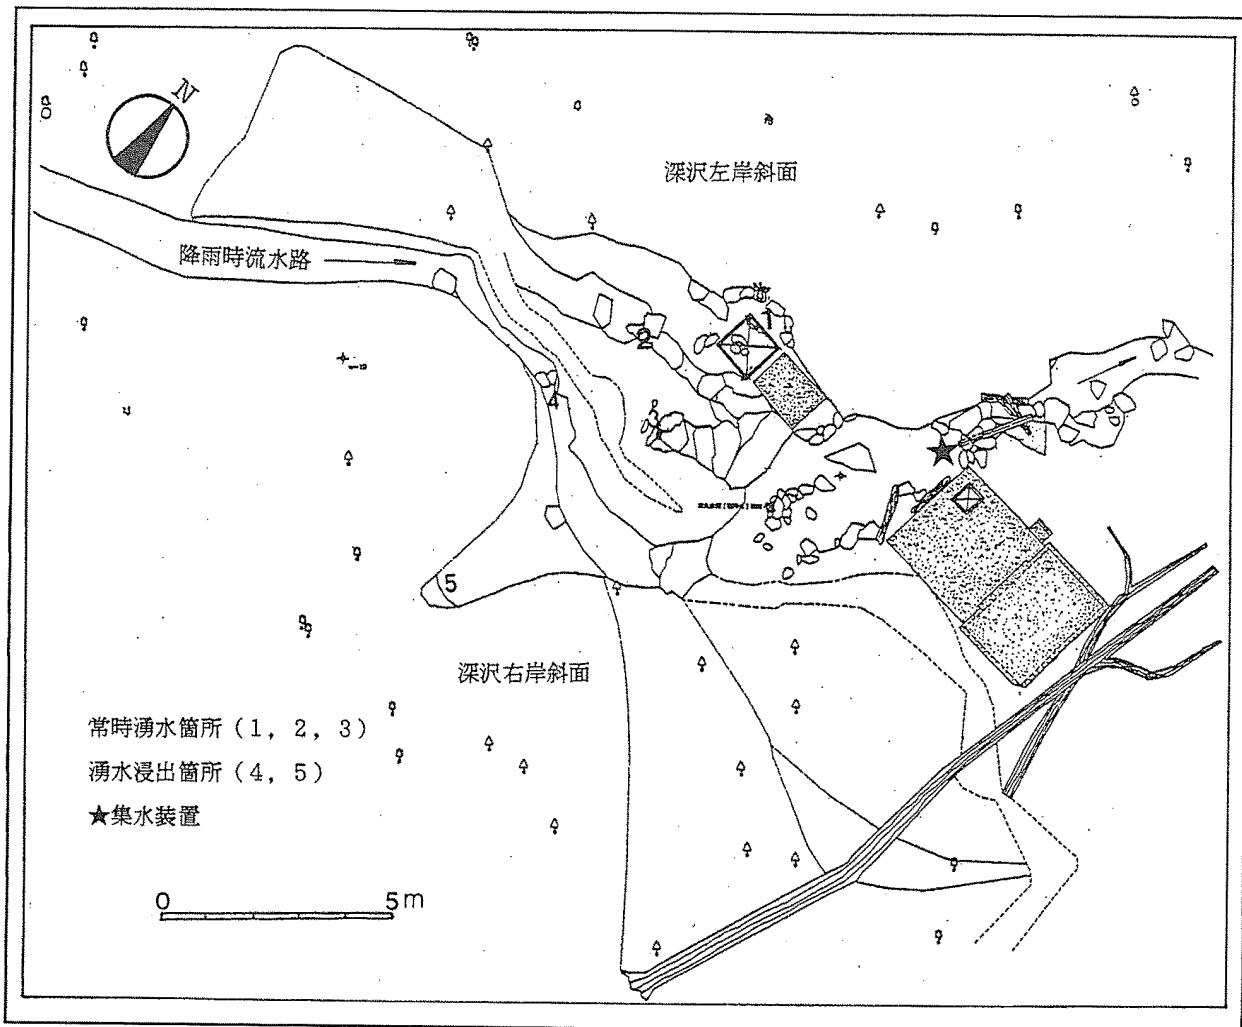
御清水湧水箇所確定平面図（縮尺1/50を縮小）
